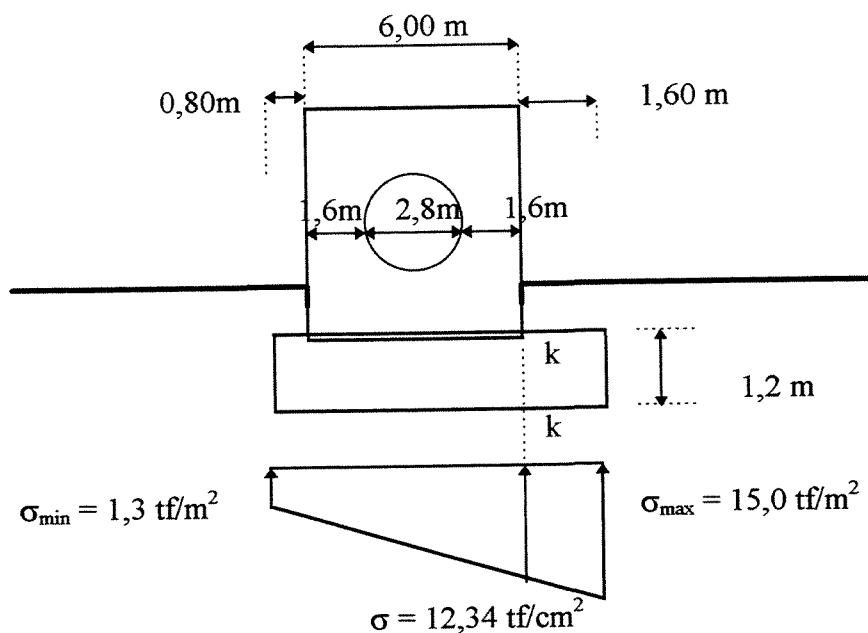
Diagrama de tensões na fundação no plano yz
